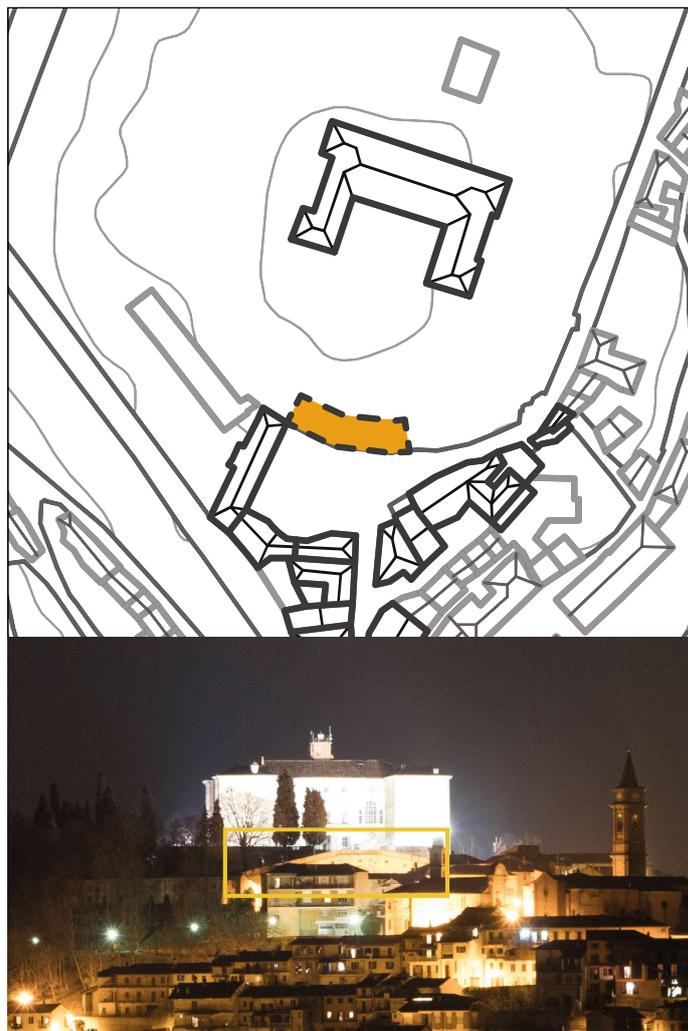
Il Muro visto dal punto di vista esterno 3.
